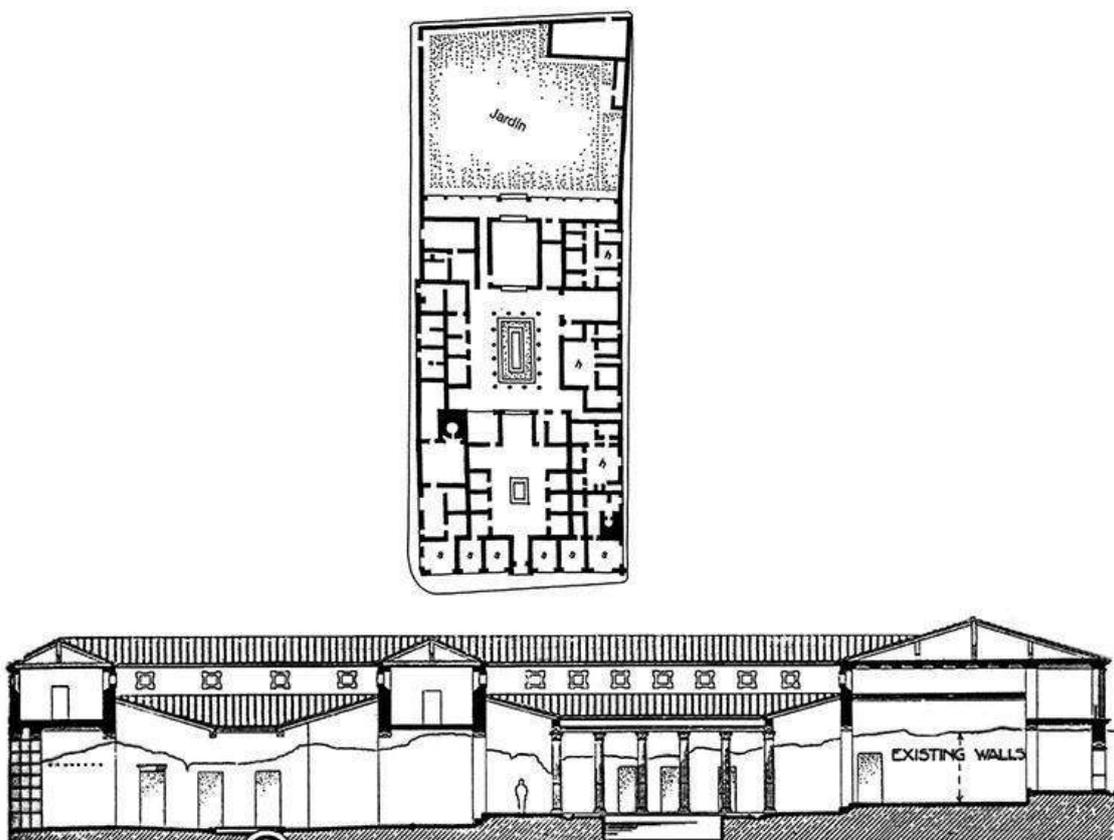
Casa de Pansa, Pompéia. Planta & corte.
